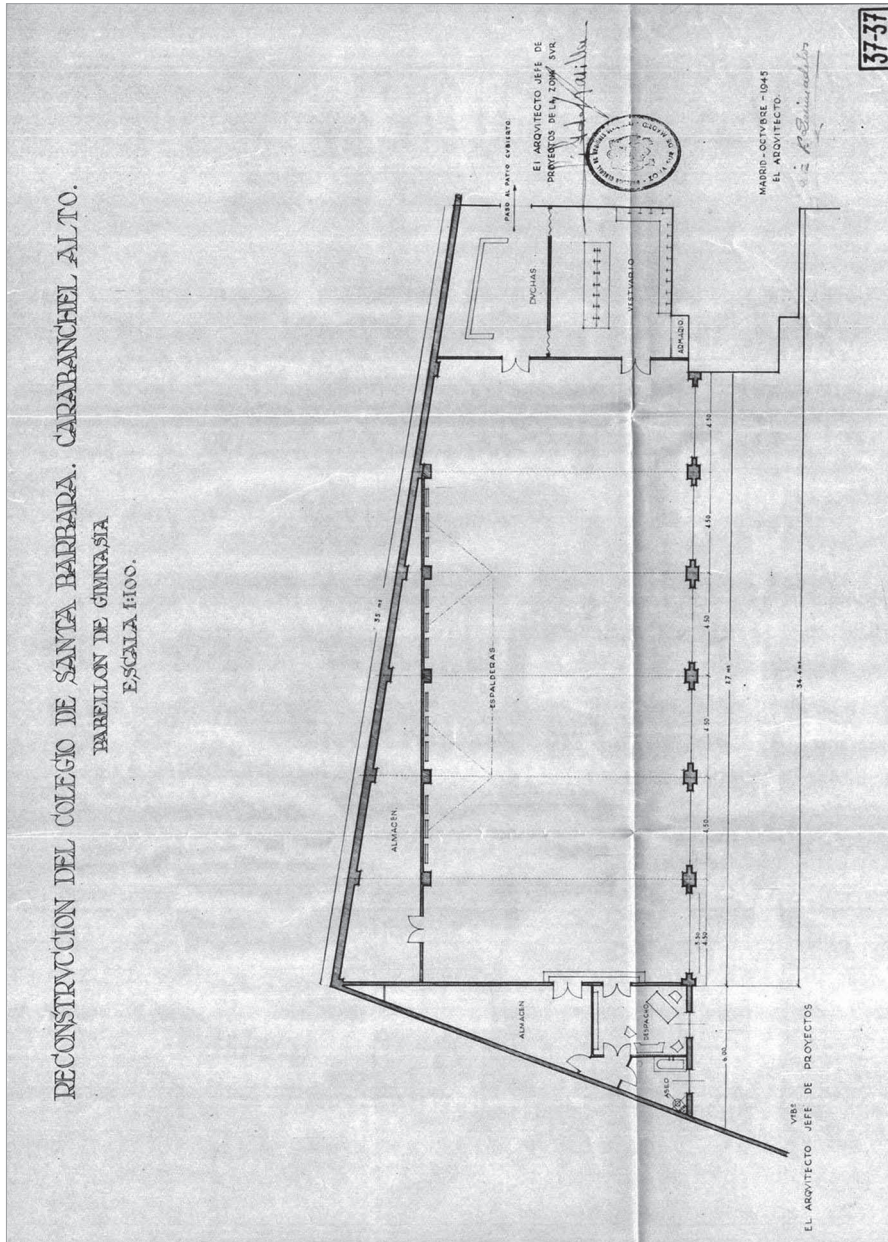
Pabellón de Gimnasia. Colegio de Santa Bárbara. Carabanchel Alto. Plano de planta, 1945. AGA, (4) 81. Caja 4179 TOP 76/03-12; (2) 81.03 2576 TOP 76/04.
